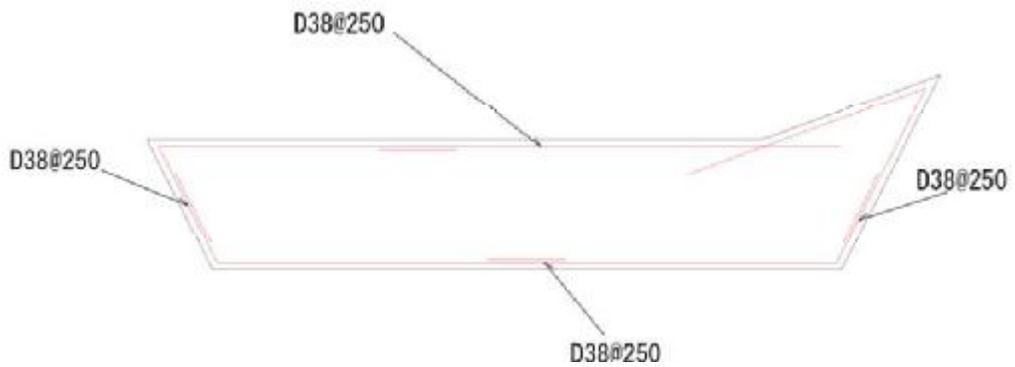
監査廊敷き置換コンクリート配筋要領図
